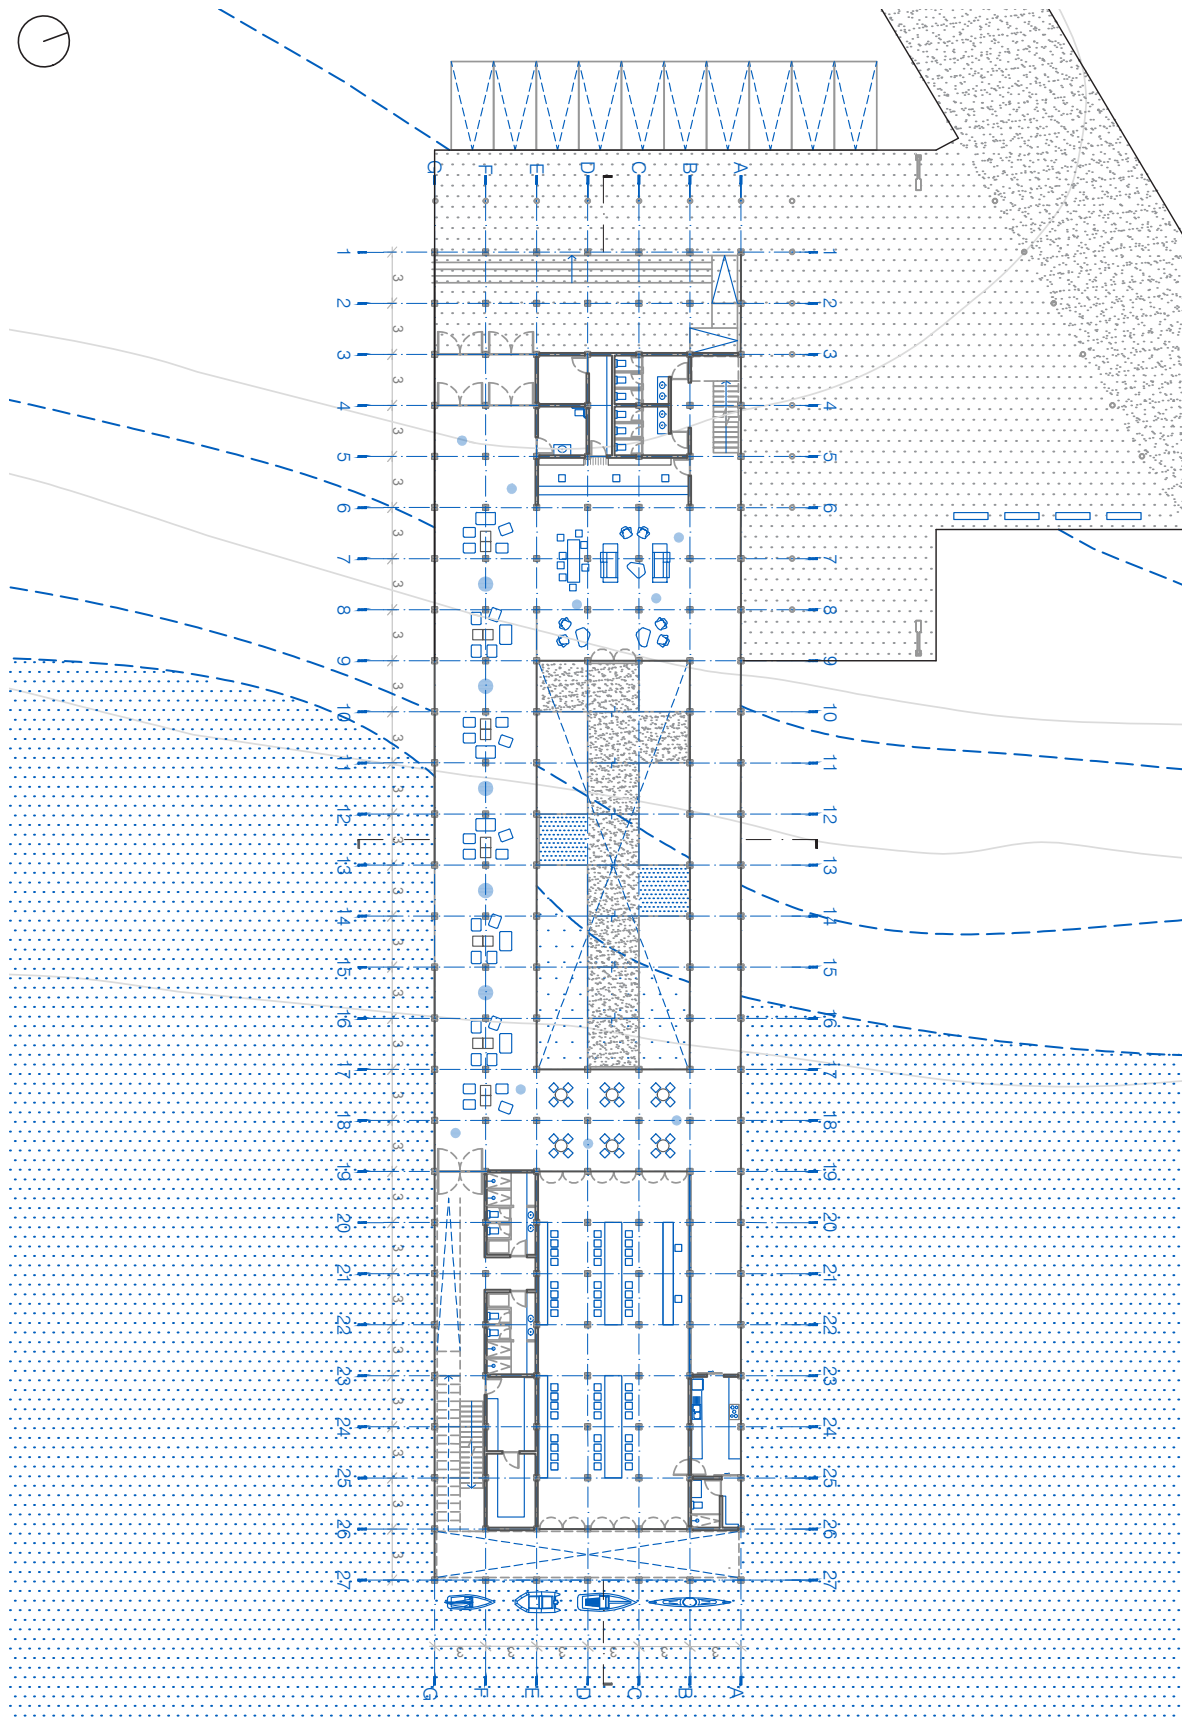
Planta Primer Piso: Difusión y Espera + Base de Buceo. Escala 1:350
